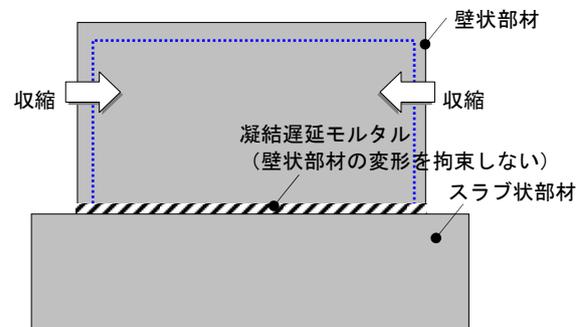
凝結遅延モルタルによるひび割れ抑制手法
